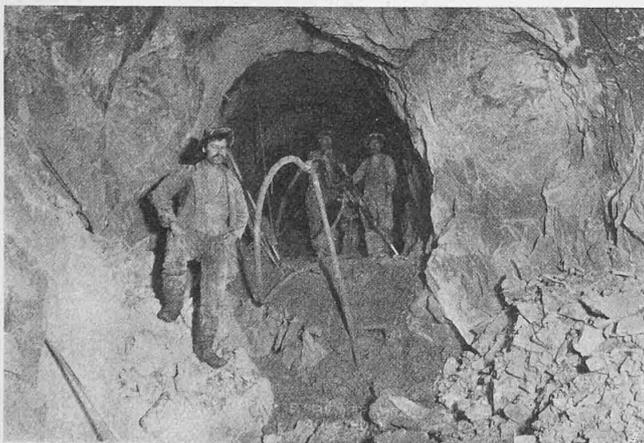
Maschinenbohrung im Firststollen der Südseite.
